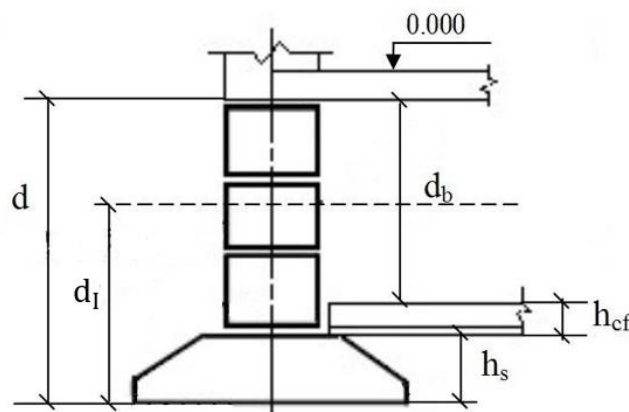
Схема для розрахунку приведеної глибини закладання фундаменту d_1
